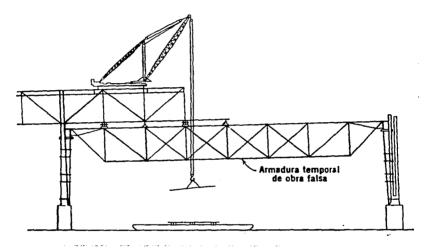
Montaje de un puente de armadura sobre una obra falsa, puente Richmond San Rafael, Bahía de San Francisco
